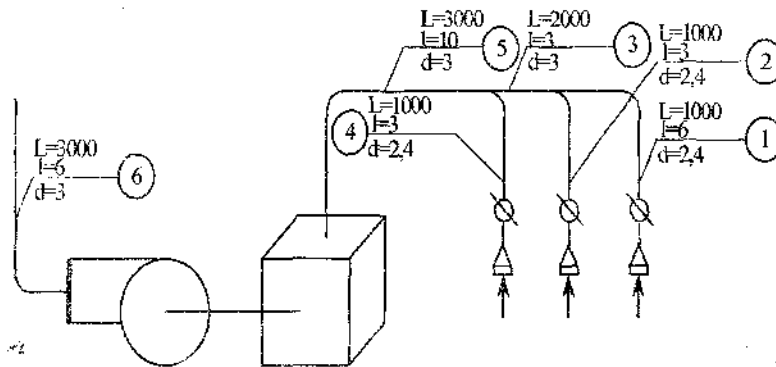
Схема витяжної вентиляції до розрахунку:
